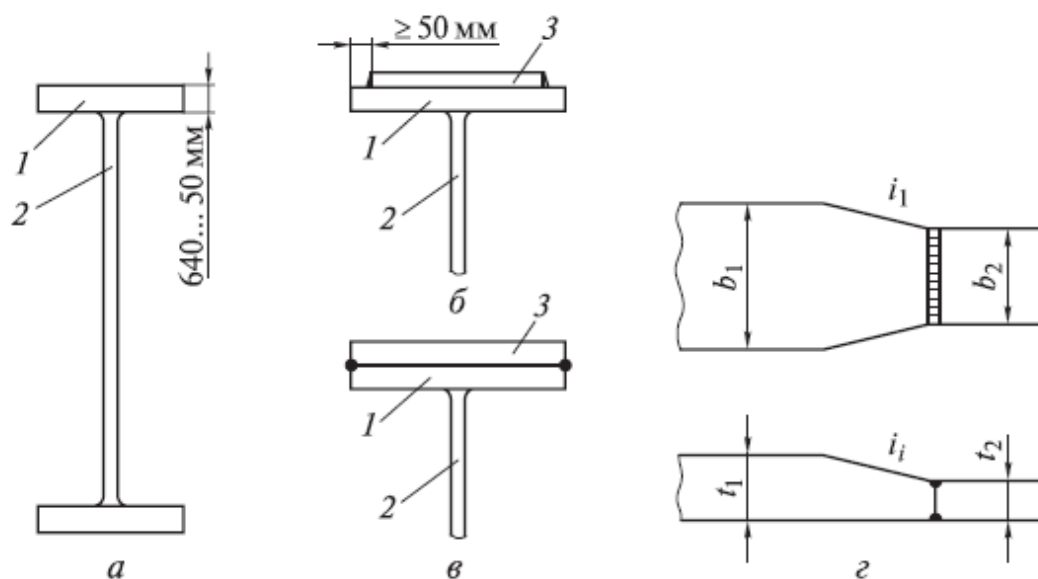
Поперечное сечение двутавровых стальных сварных балок и способы изменения площади их поясов по длине пролета:
